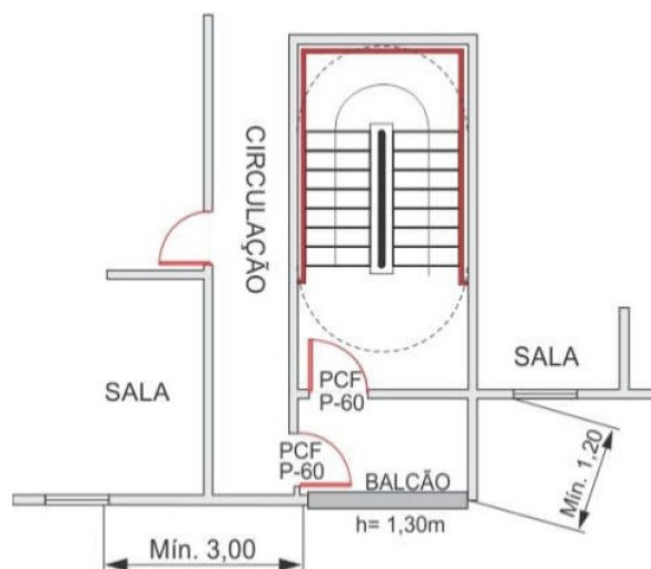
Escada enclausurada do tipo PF ventilada por balcão
